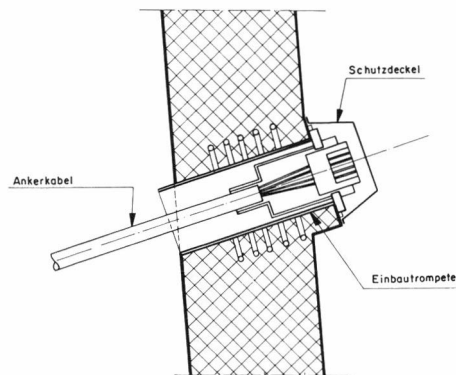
Detail Ankerkopf – Détail de tête d'ancrage – Detail of anchor head (VSL Type EA35 5–7)
